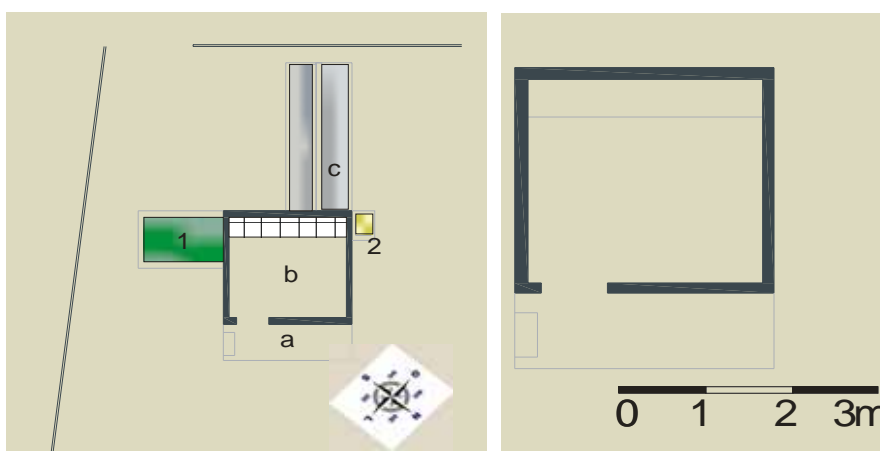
Configuração da área circunvizinha a Fabriqueta 2 e planta baixa da Fabriqueta 2.
